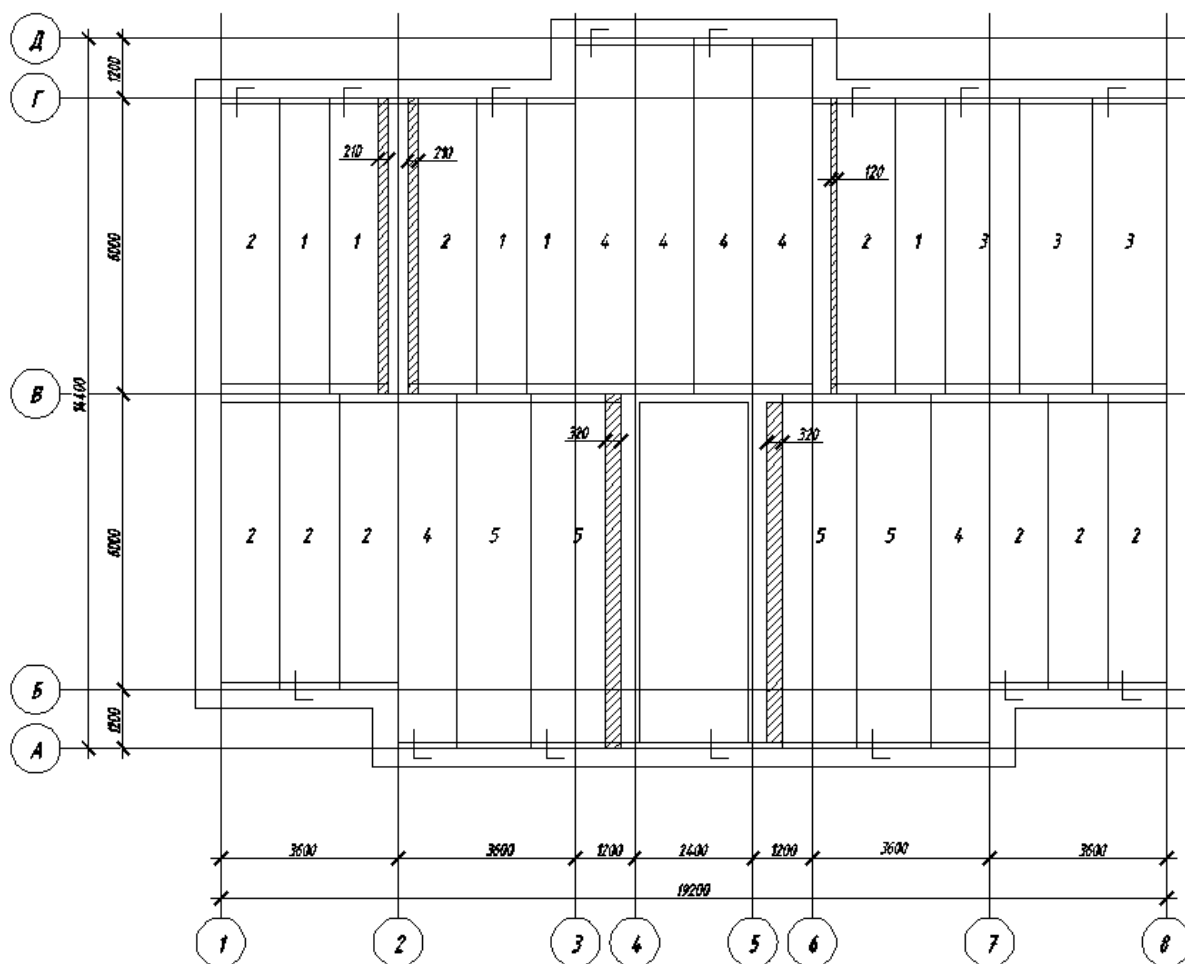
Раскладка плит перекрытий на отметке 2,700 и -0,100
